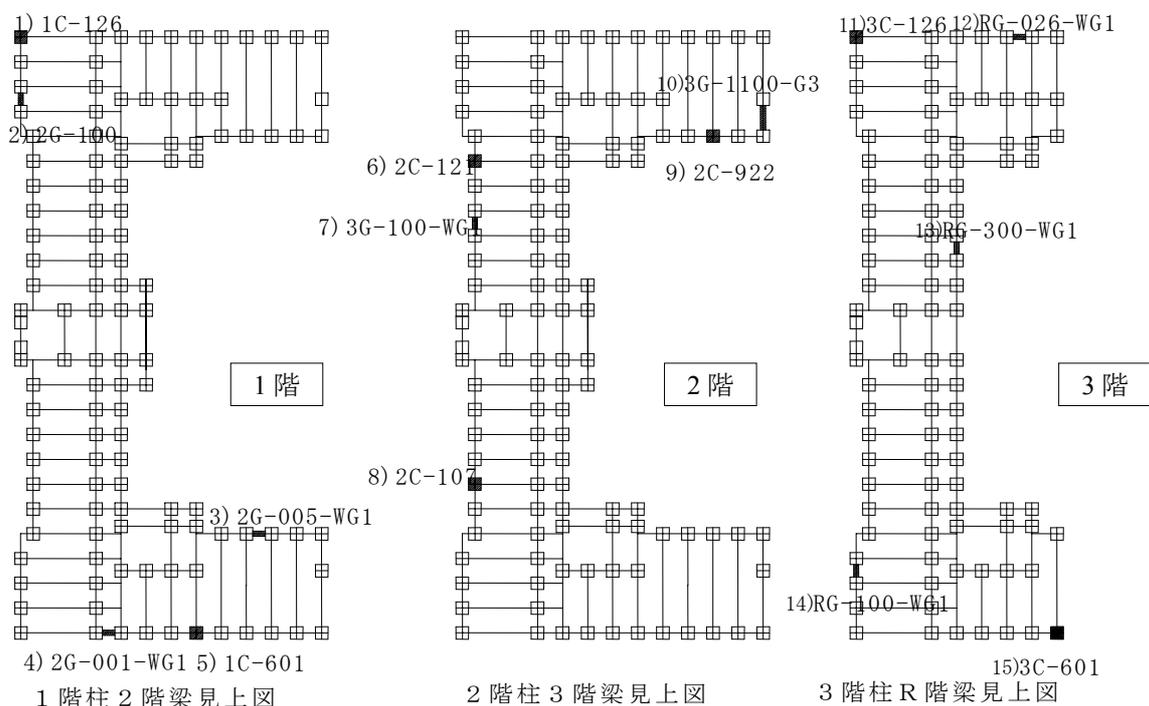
コア採取位置 (平面図) (黒塗部が採取位置を示す)
